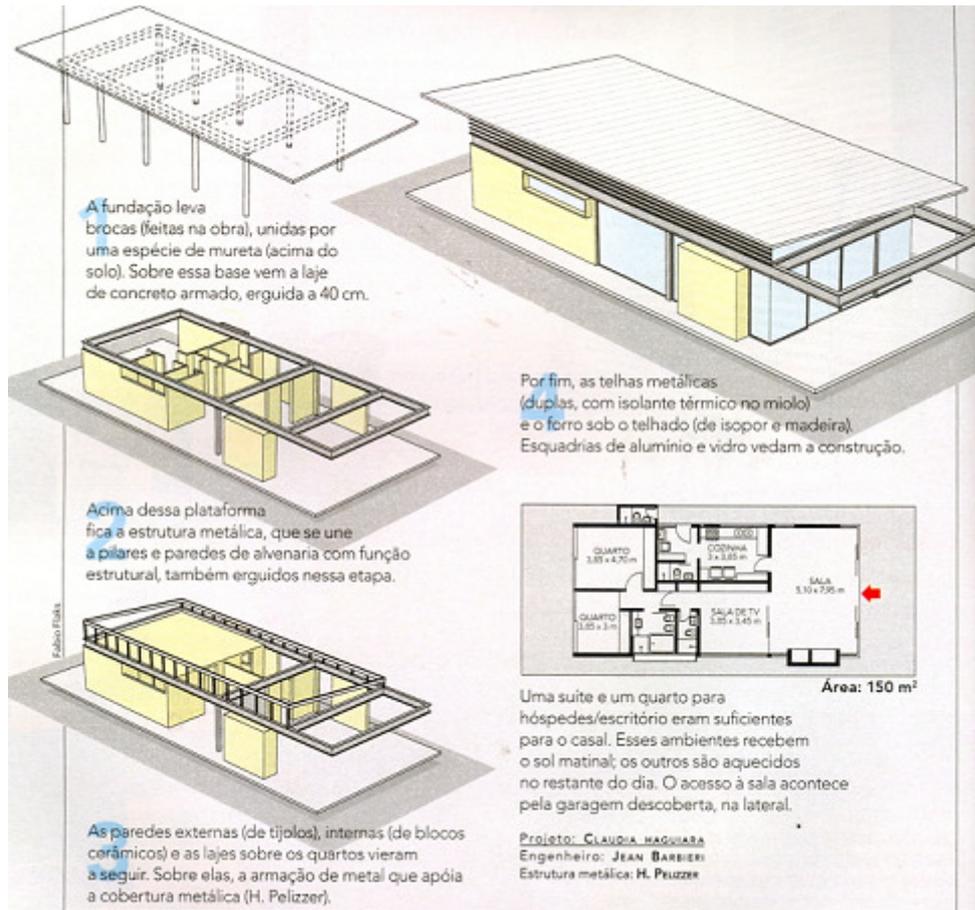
Pilares acima do solo e lajes pré- moldada com estrutura metálica
